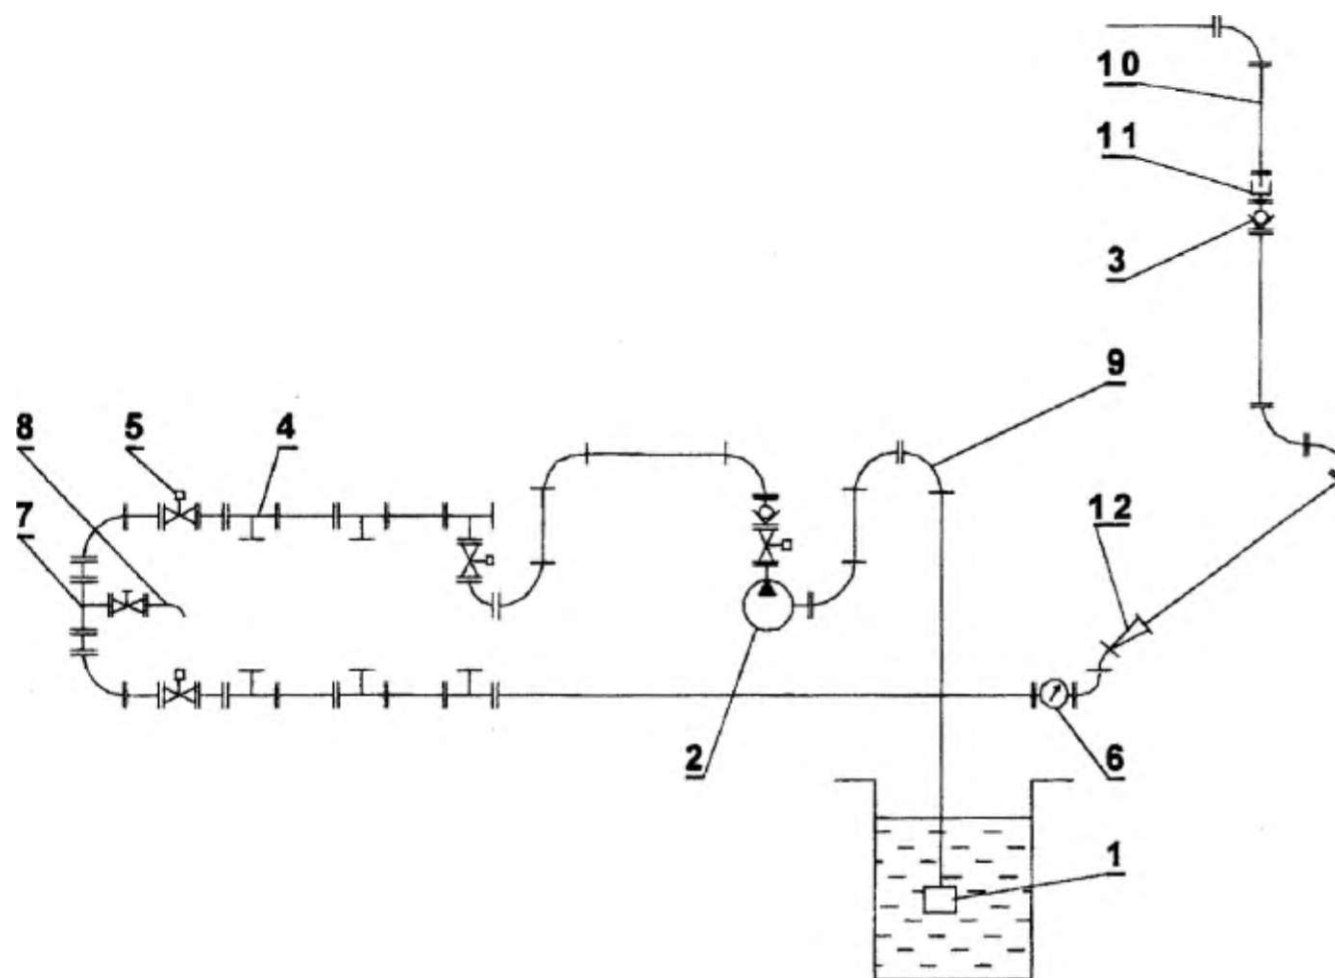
Расчётная схема для включения одного насоса на индивидуальный трубопровод:
